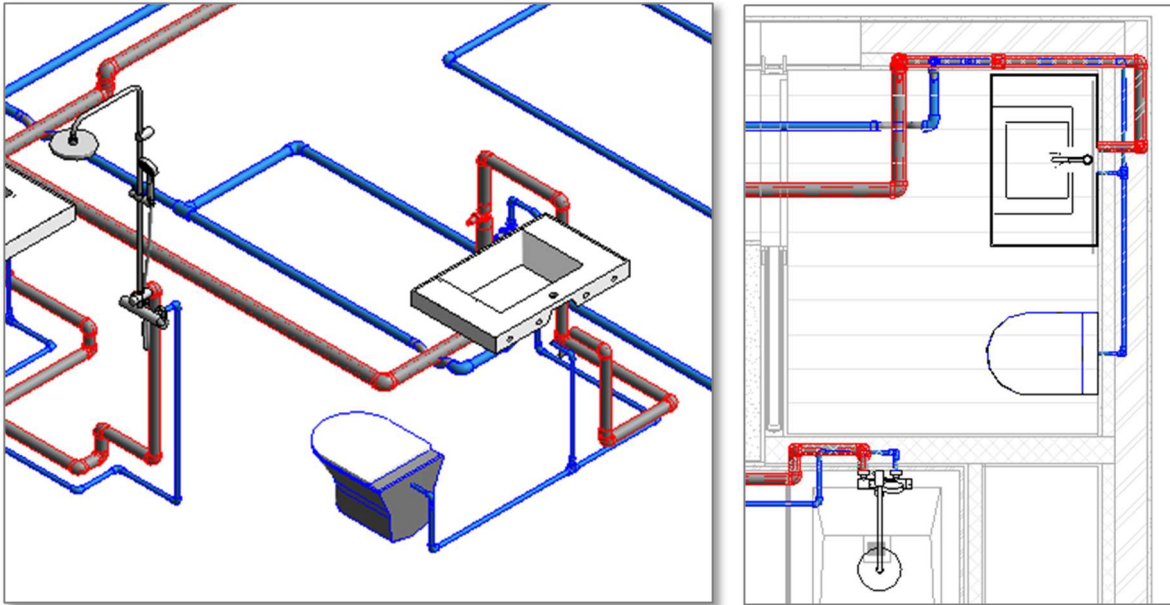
Situação 1 da Figura 6.16 - Alteração da configuração da instalação sanitária (Fonte: Elaboração própria)
